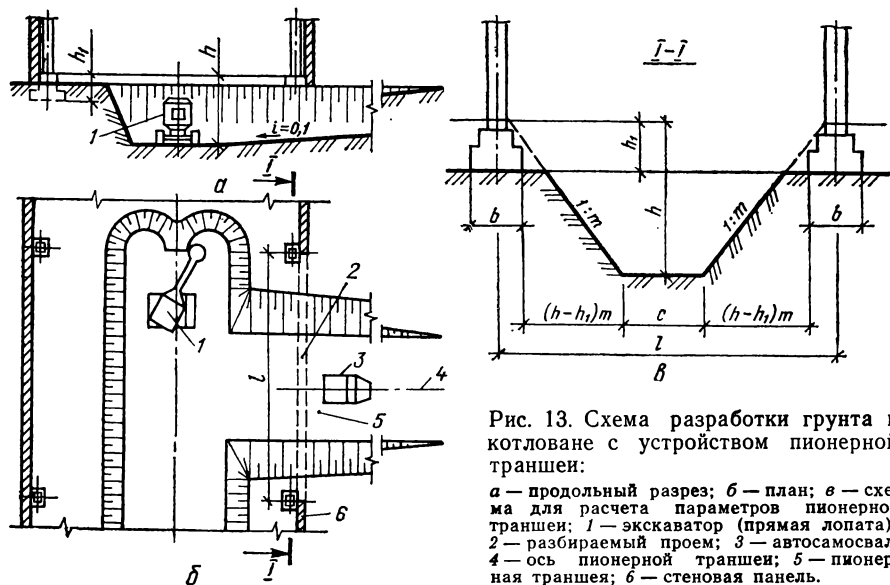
Схема разработки грунта в котловане с устройством пионерной траншеи:
